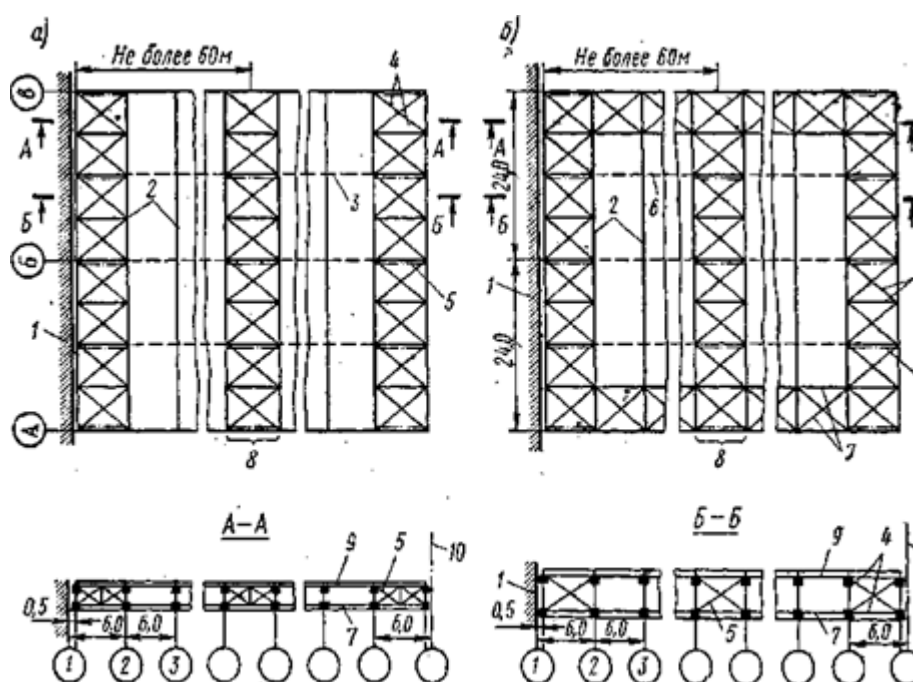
Связи в покрытии по стальным фермам (схема): а - по верхнему поясу; б - по нижнему поясу; 1 - торцовая стена; 2 - стропильные фермы; 3, 6 - распорки; 4 - горизонтальные связи поперечные; 5 - вертикальные связи; 7 - горизонтальные связи продольные; 8 - промежуточный жесткий блок (при длине температурного блока больше 60 м); 9 - плиты покрытий; 10 - ось температурного шва
